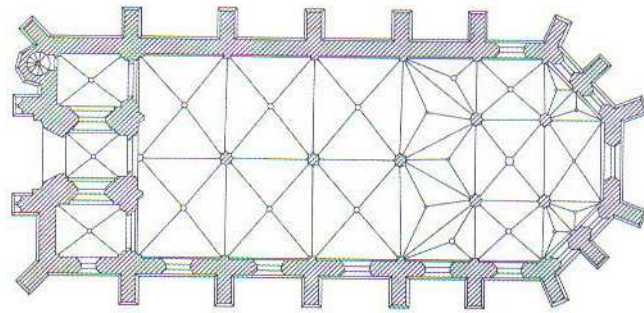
Grundriss der Wallfahrtskirche Maria Pöllauberg
